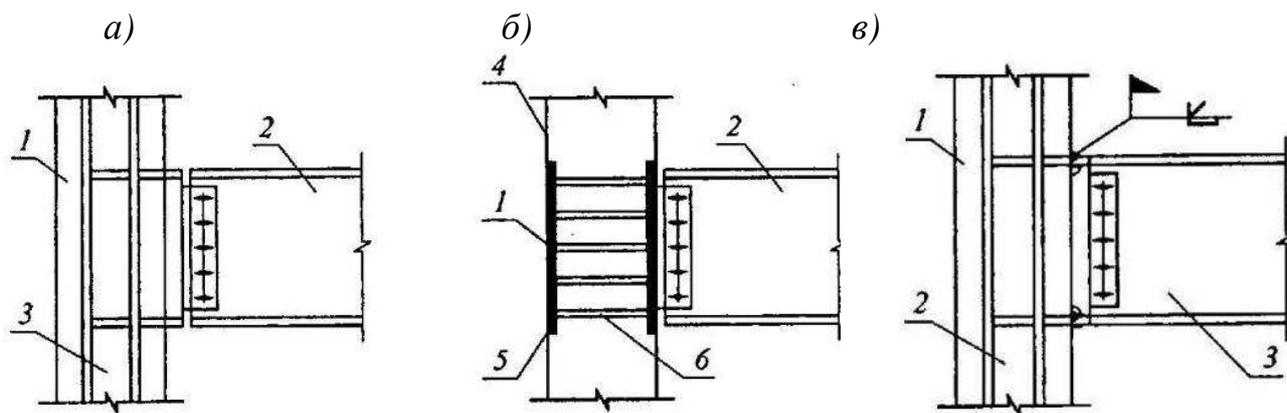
Узлы соединения железобетонных стен и стен-диафрагм со стальными балками каркаса: а и б – варианты шарнирного соединения; 1 – железобетонный элемент; 2 – конструкция стальной балки; 3 – закладная деталь в колонне; 4 – конструкция железобетонной стены; 5 – стальные пластины закладной детали в стене; 6 – соединительные арматурные стержни в закладной детали; в – вариант жесткого соединения: 1 – железобетонная стена; 2 – закладная деталь в теле стены; 3 – конструкция стальной балки
